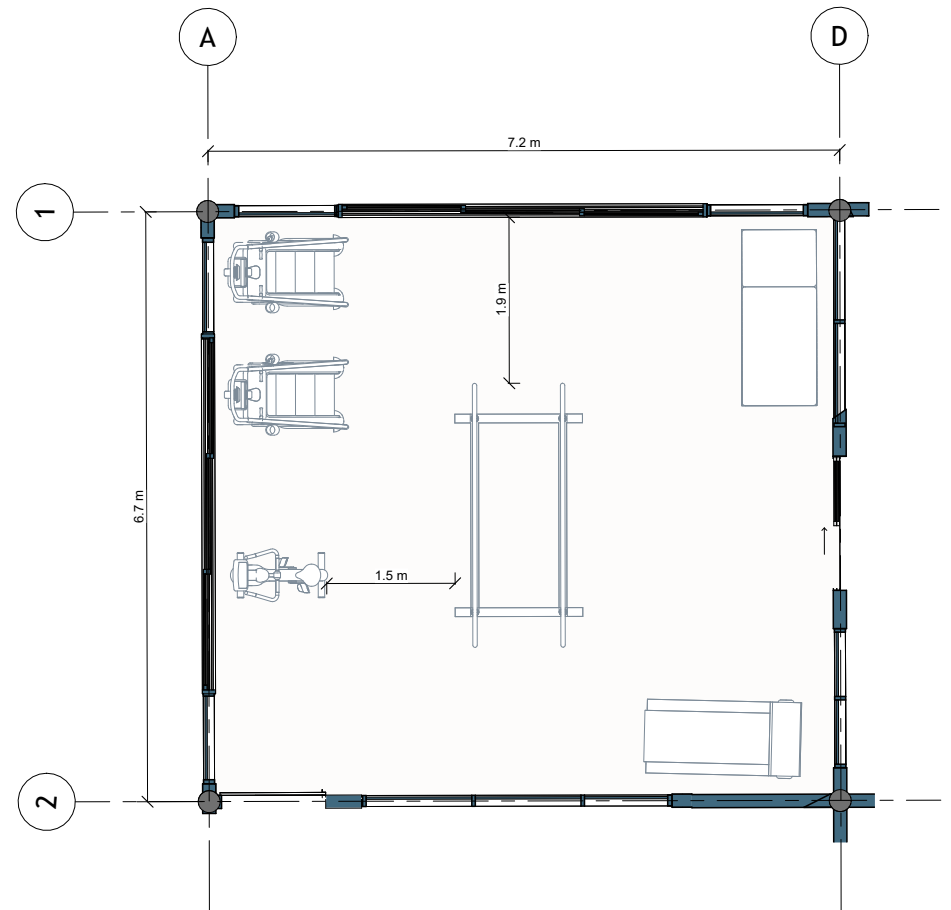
Planta arquitectónica de terapia física. Fuente: Elaboración propia.
